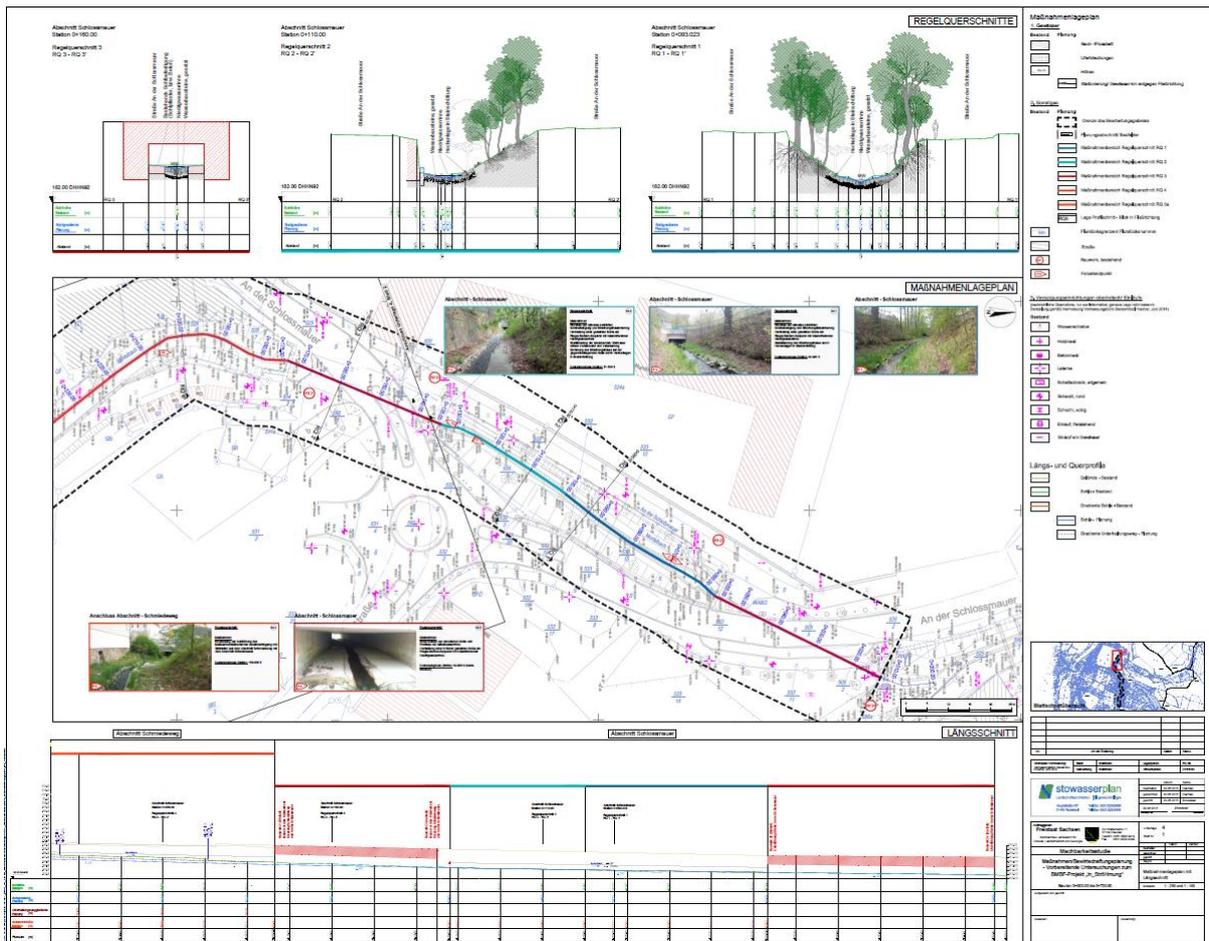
Planunterlagen zur Revitalisierung des Mortelbaches in Waldheim (Stowasserplan GmbH)
